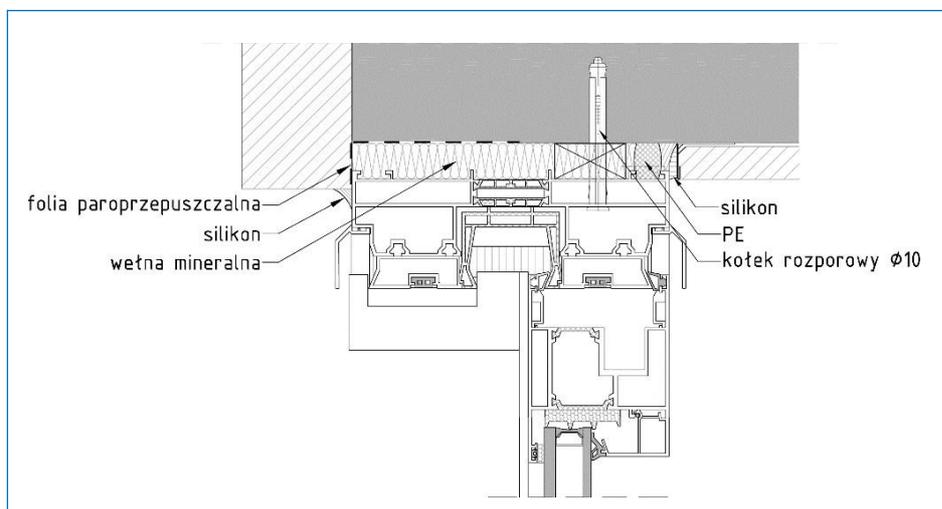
Esempio di montaggio della porta finestra in una parete solida isolata dall'esterno - sezione verticale attraverso l'architrave
